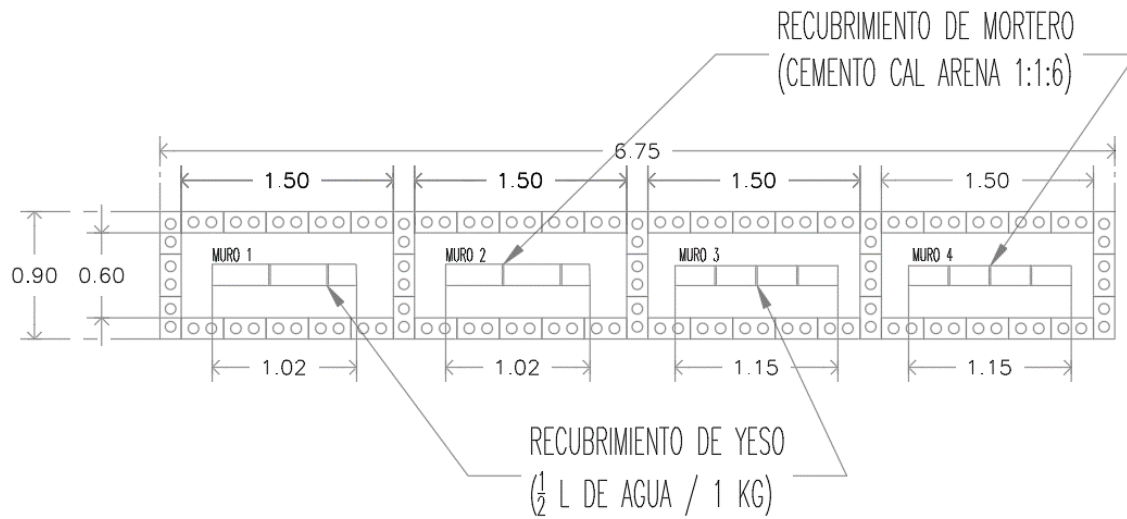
Muro recubierto de Yeso (Muro 1 y 3). Imagen del autor.
